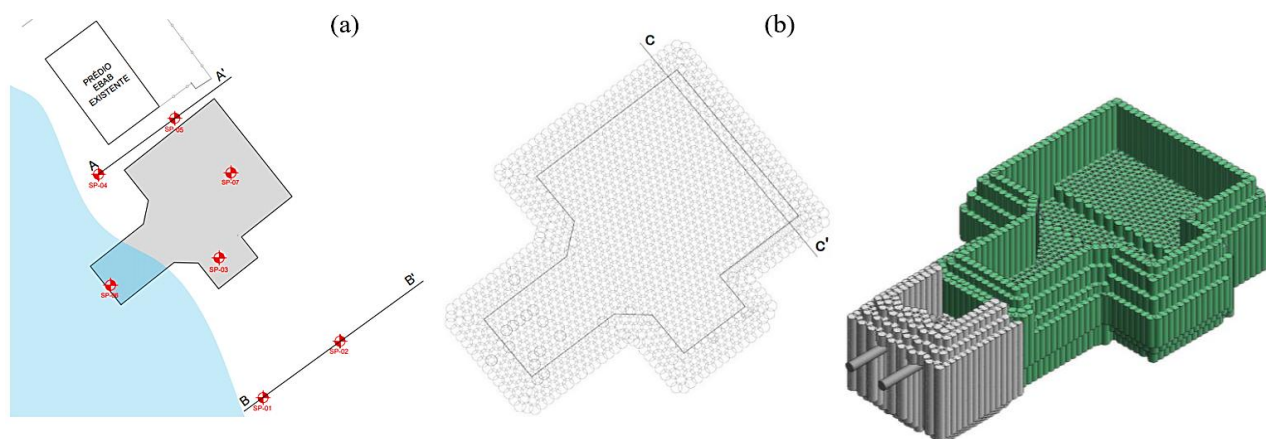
Localização das sondagens e projeção das colunas de jet grouting.
